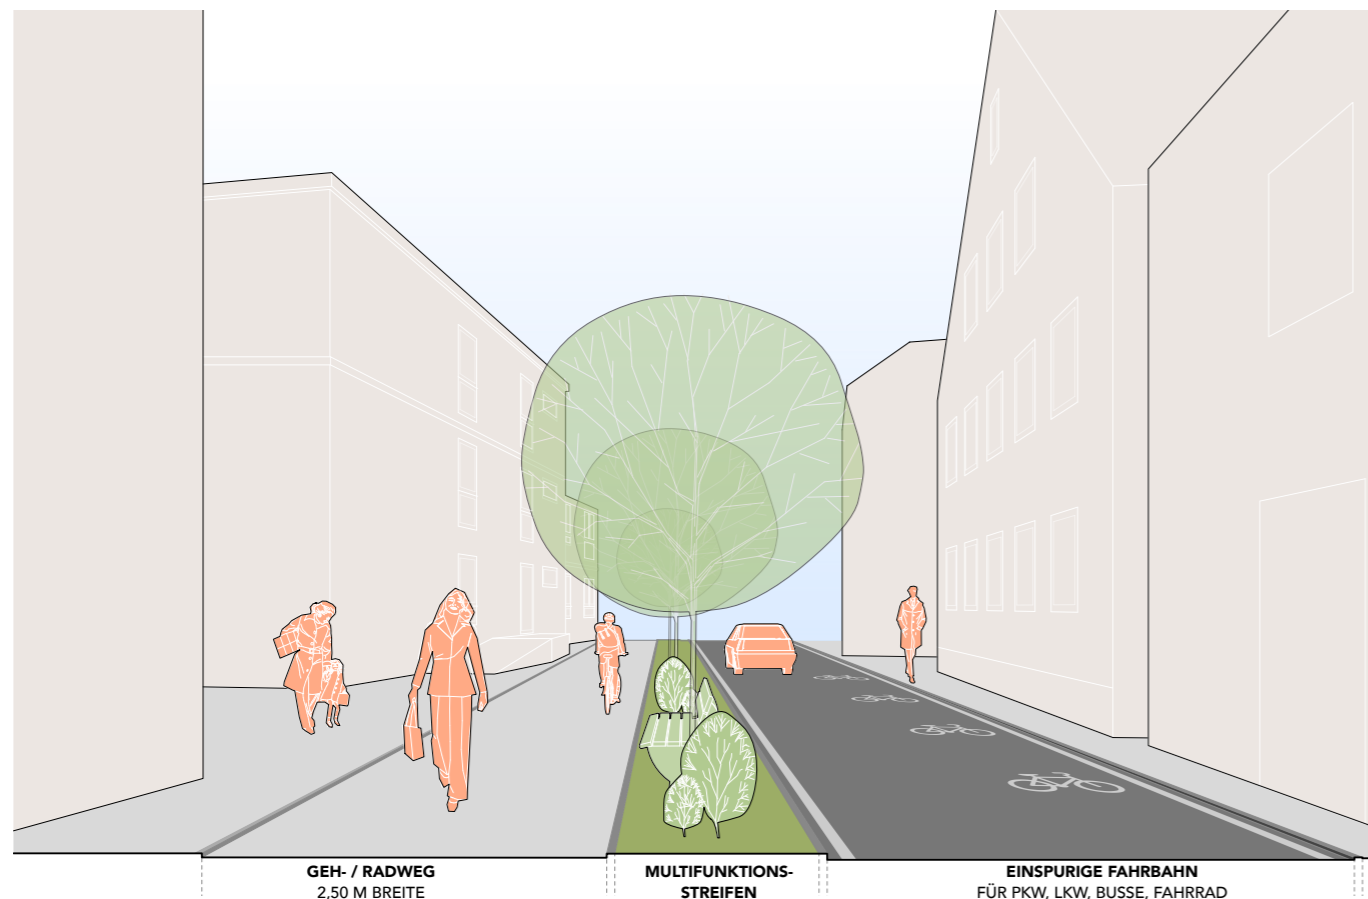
Mögliche Umgestaltung Weißdorfer Str. mit Einbahnstraßenregelung, Blick Richtung Norden
